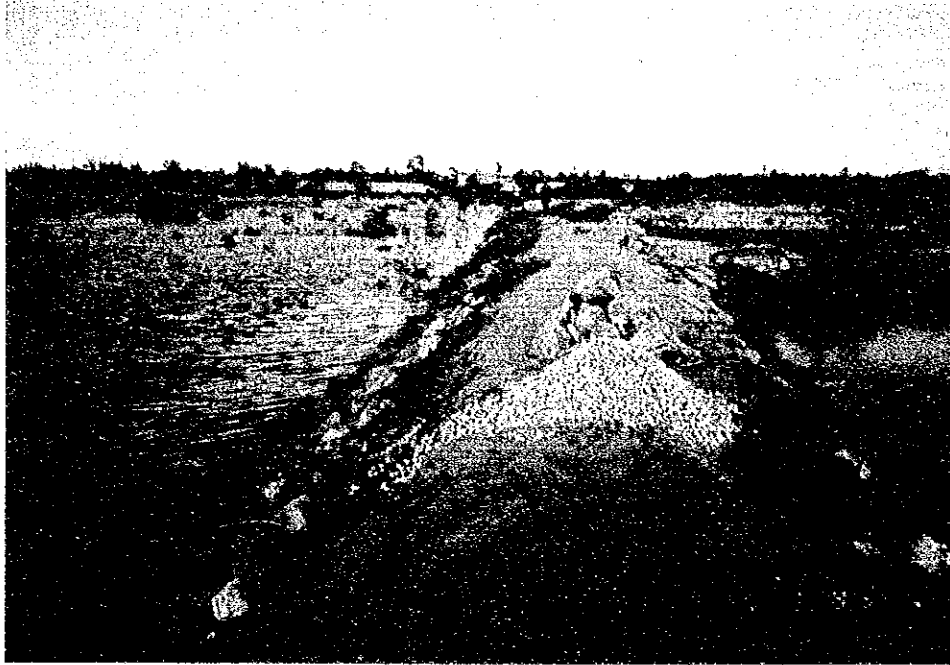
Levée de terre d'un bassin de culture à l'essai existant
